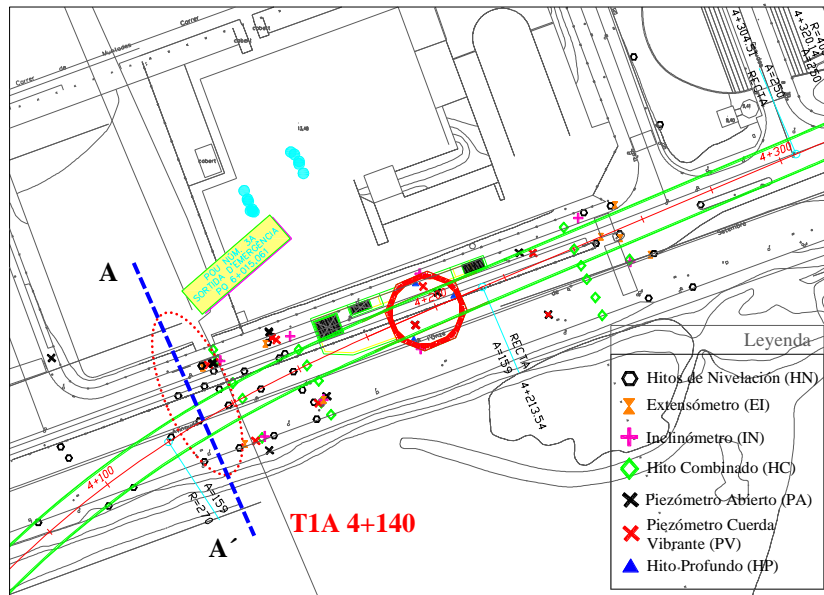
28. Situación en planta del túnel y la sección de control T1A PK 4+140
